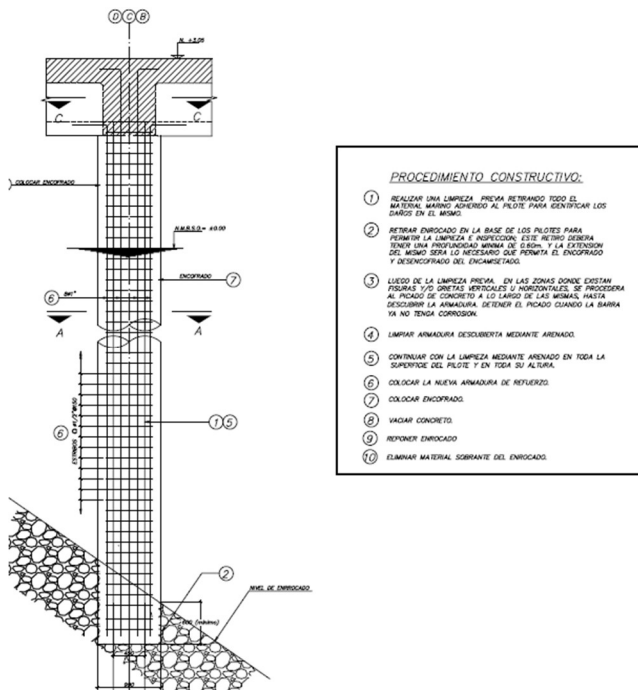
Encamisetado o reforzamiento de los pilotes existentes.
